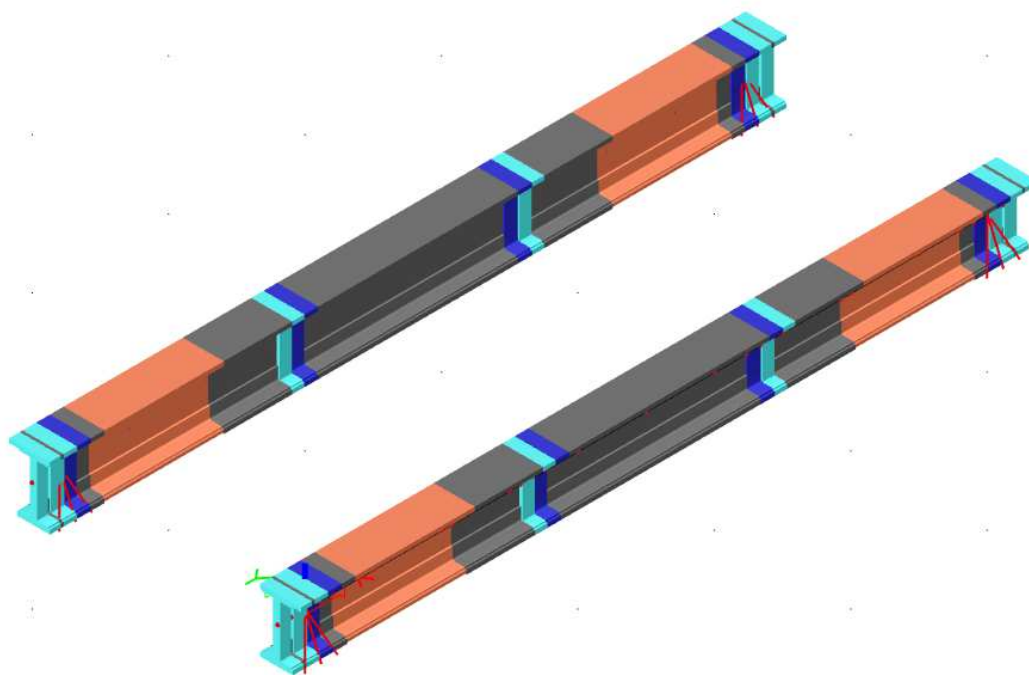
model konstrukce se zobrazenou geometrií průřezů
